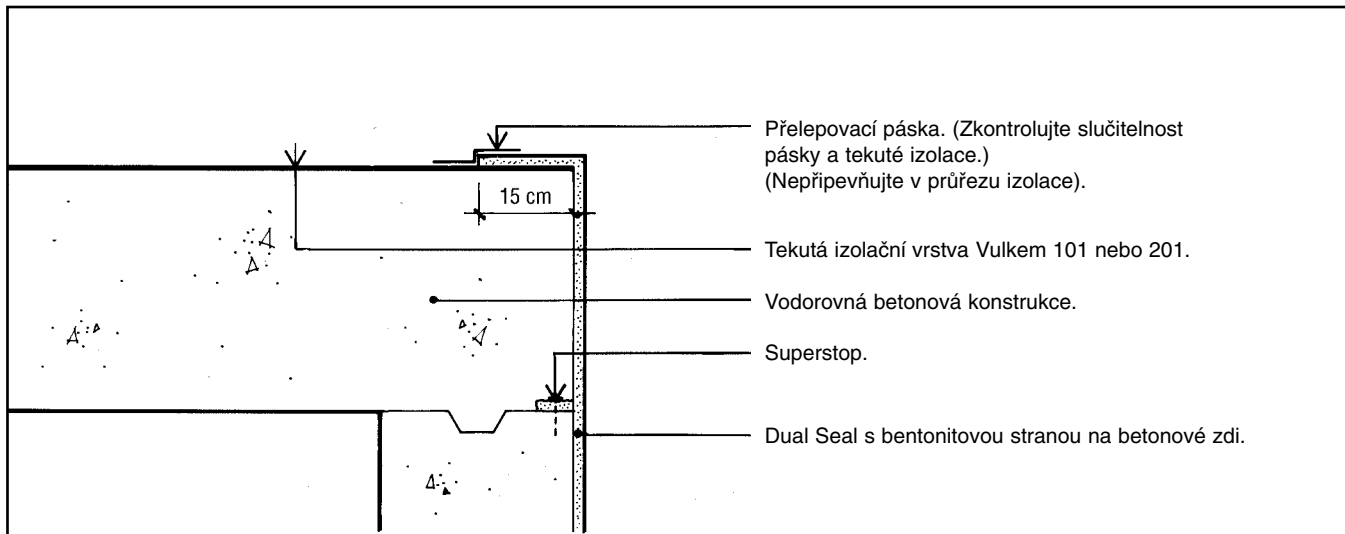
Instalace Dual Seal LG na zeď spojenou s podlahou.
